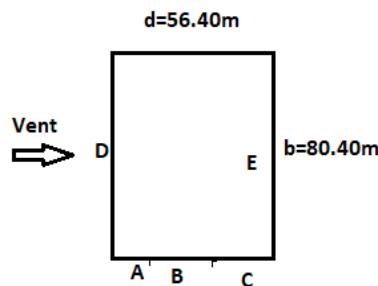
Vue en plan du direction du vent suivant le Long pan.
